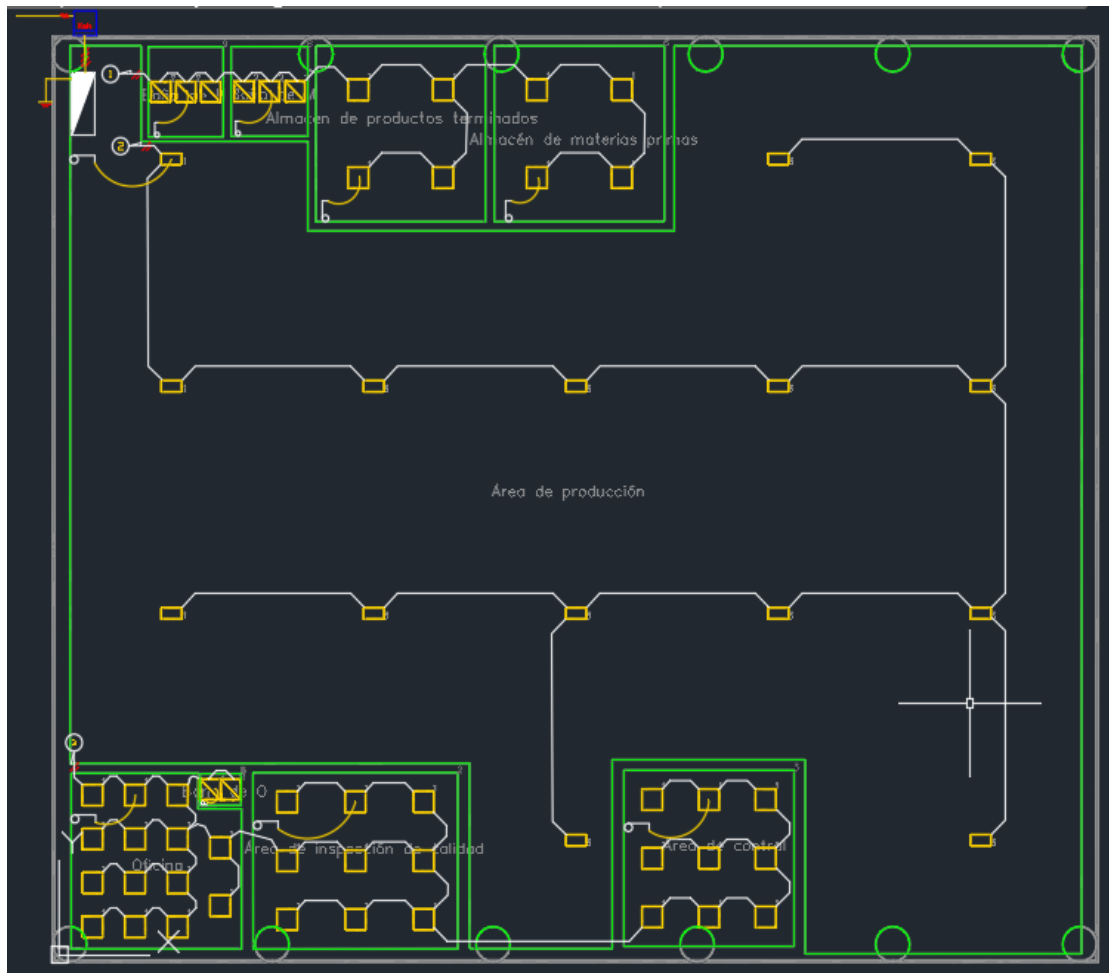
Plano eléctrico de luminosidad en AutoCAD. Fuente: Autores.
